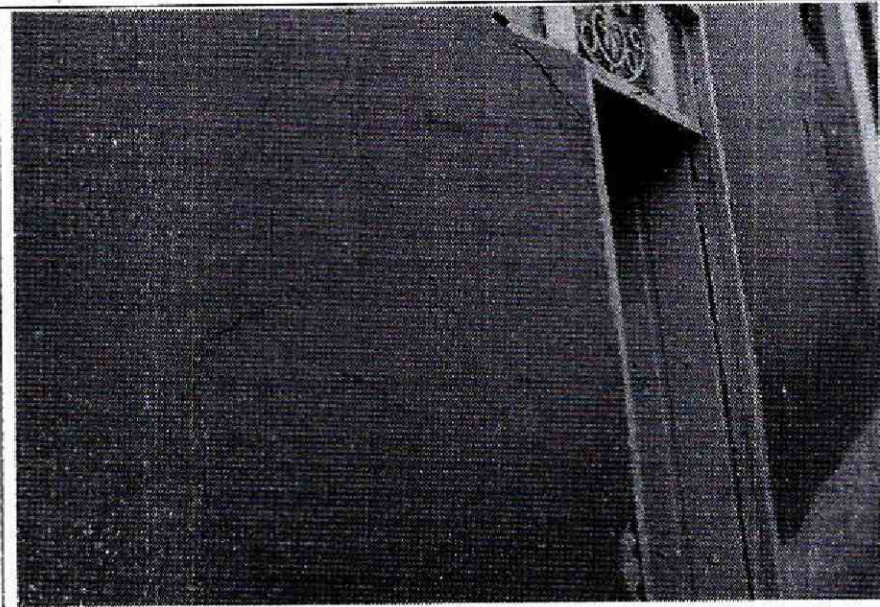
Fisuras y grietas en el extremo sur de la fachada.
